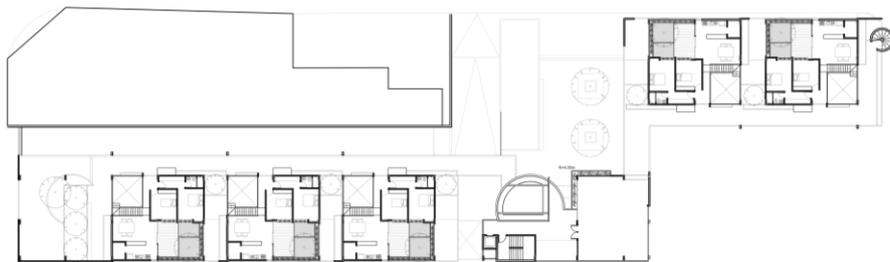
Plantas arquitectónicas. Parte I. Elaboración propia
